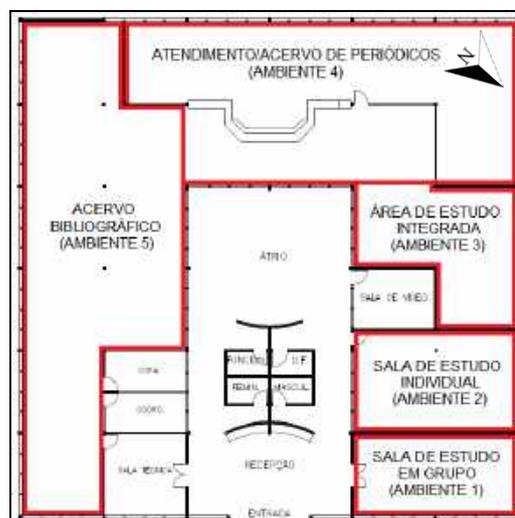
Planta baixa da biblioteca. Fonte: Os Autores.
